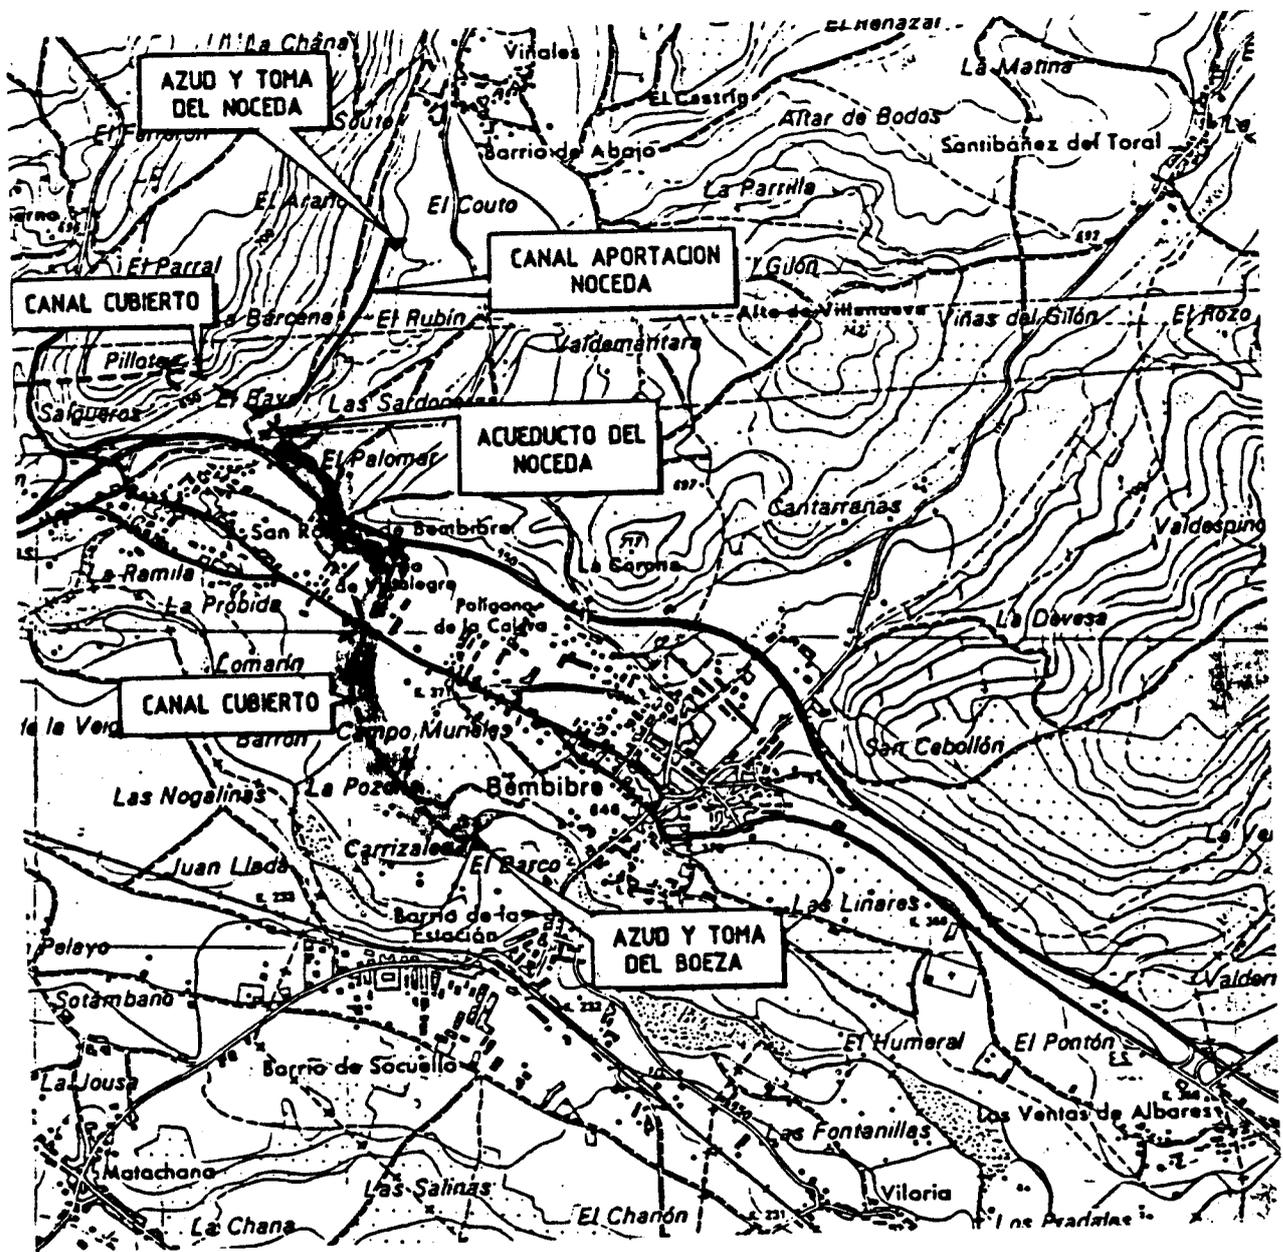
PLANO DE SITUACION DE LAS OBRAS
